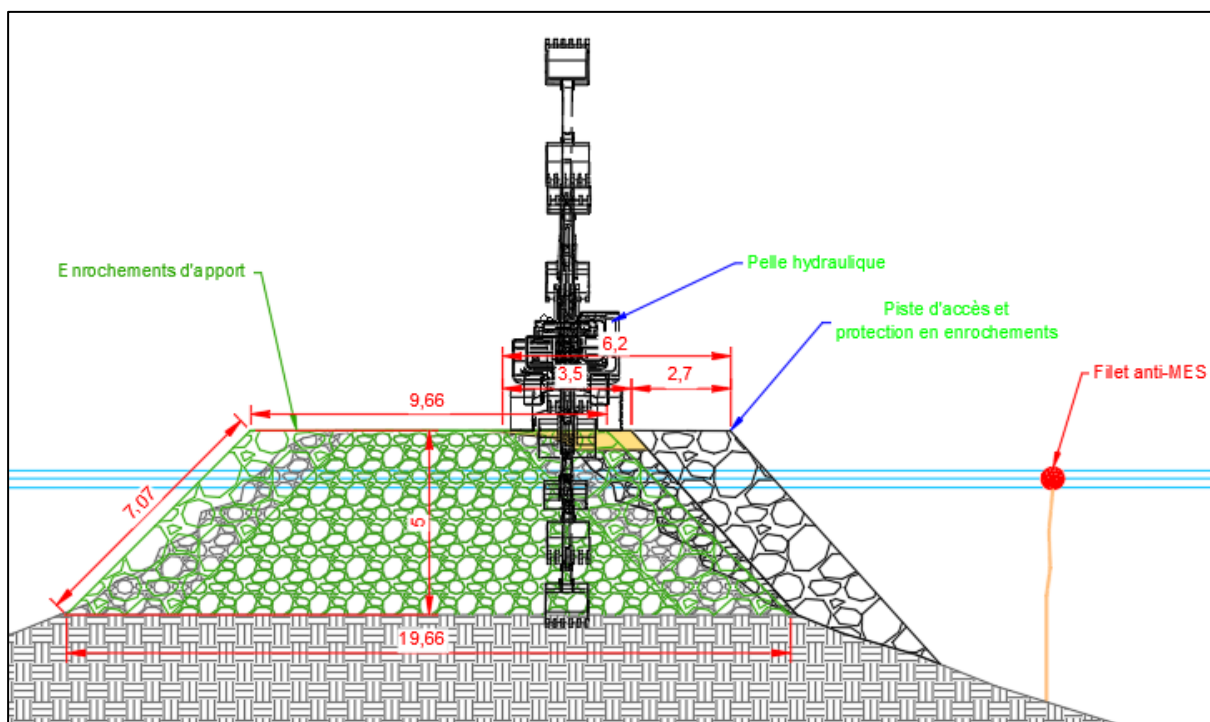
Coupe de la contre-jetée lors des travaux par voie terrestre
